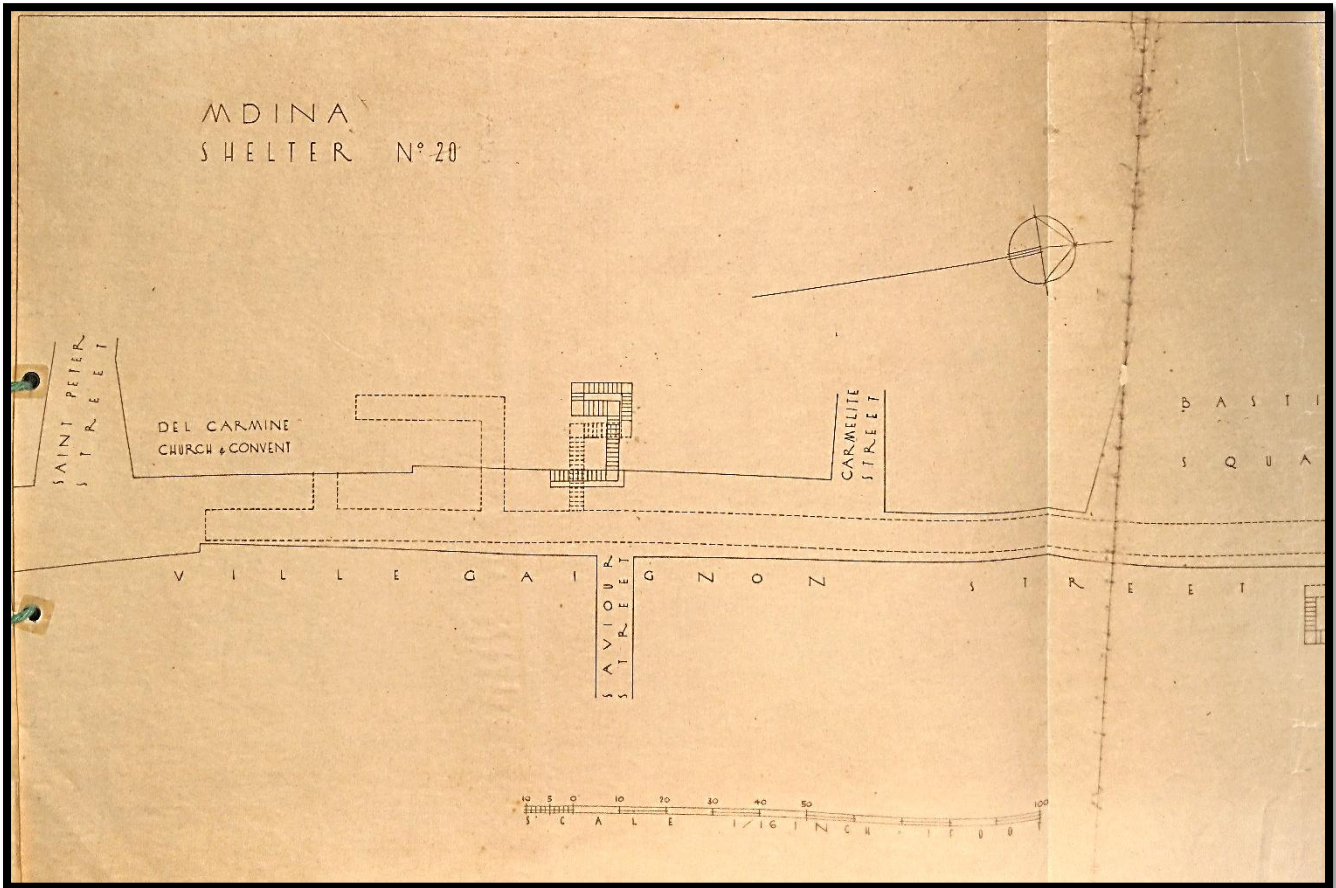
Planta do Abrigo nº20 (5) "Saint Peter Street – Villegaignon Street – Saviour Street – Carmel Street."
